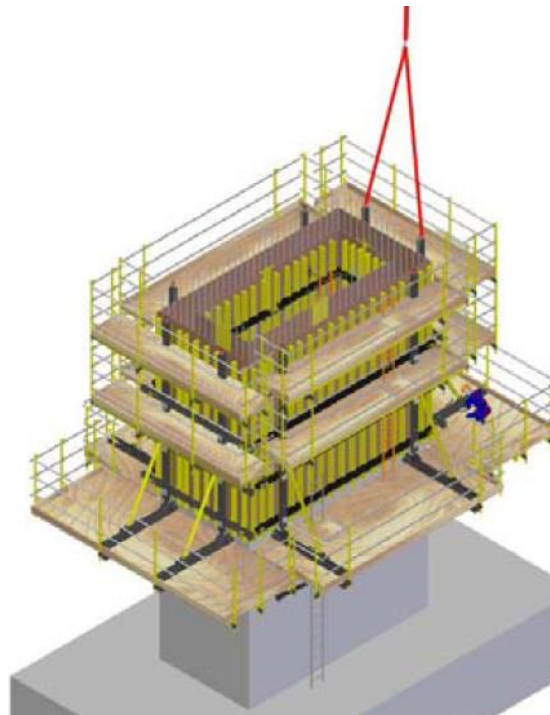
ab. Izado y posicionamiento de los paños exteriores con grúa. Recuperado de: Ulma Construction, *Instrucción técnica de montaje.
